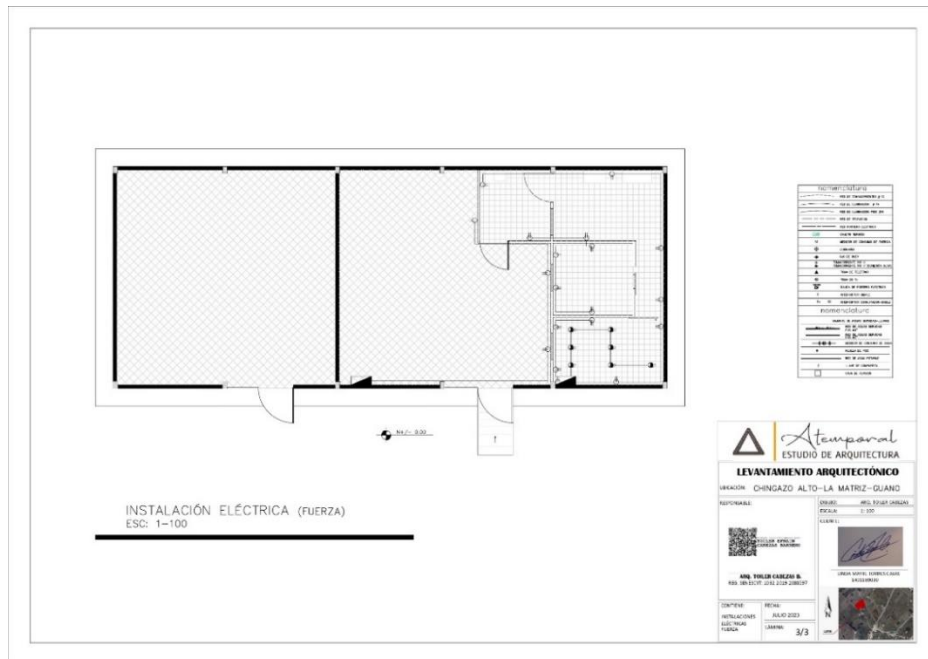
Planos eléctricos (fuerza) del Laboratorio
